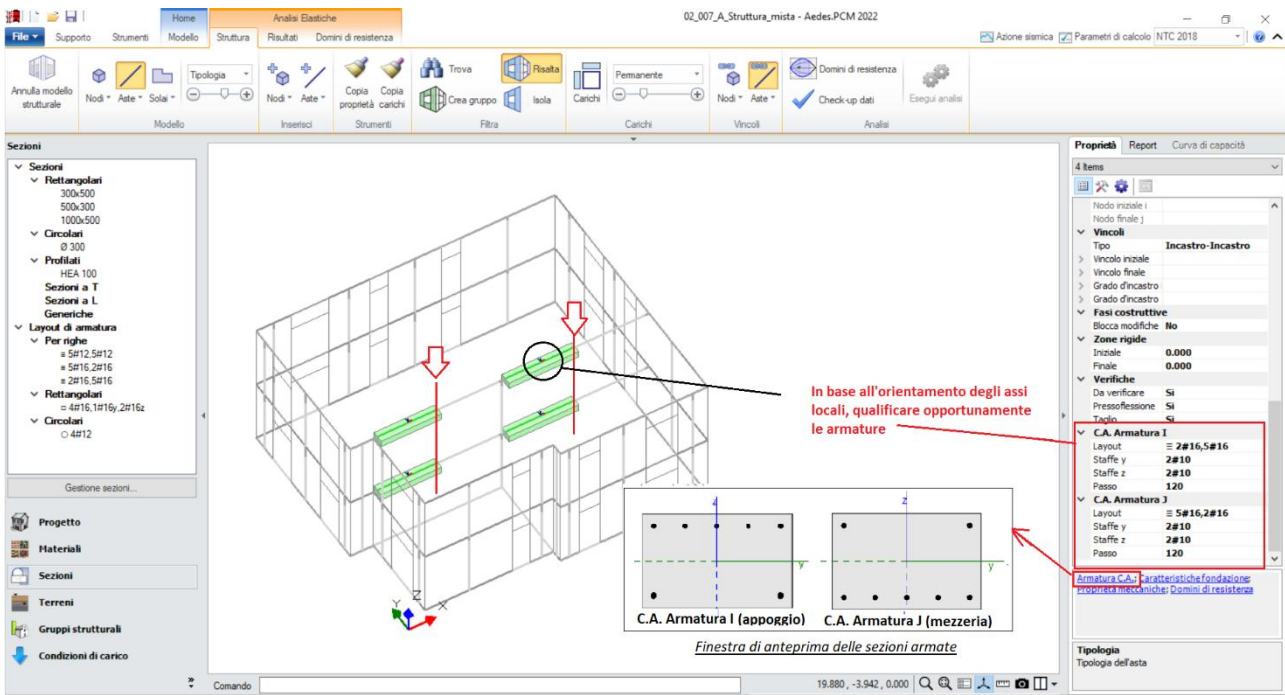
Selezione Travi in Elevazione e assegnazione armature sulla prima metà
